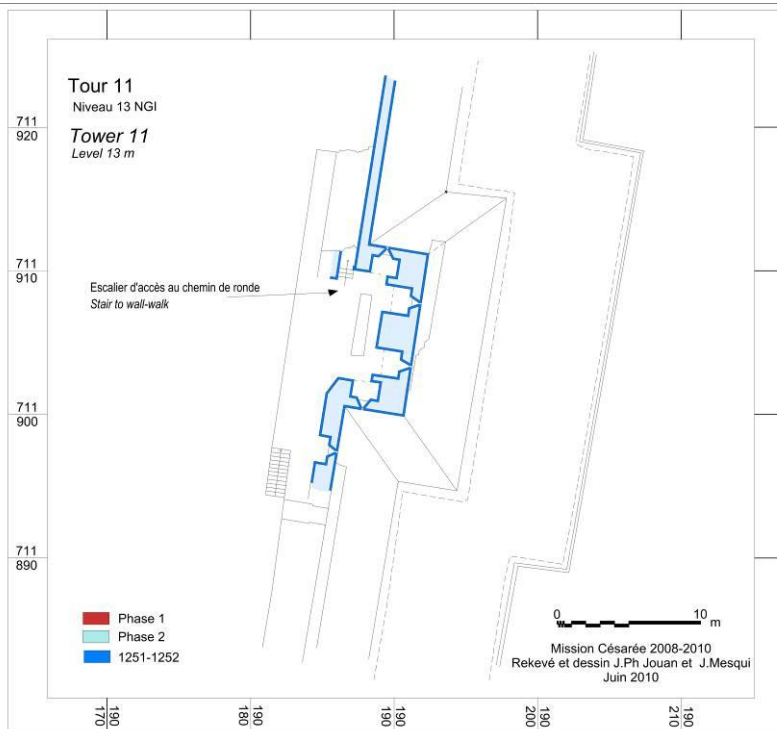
Plan de la tour T11 au niveau 13 m ASL
